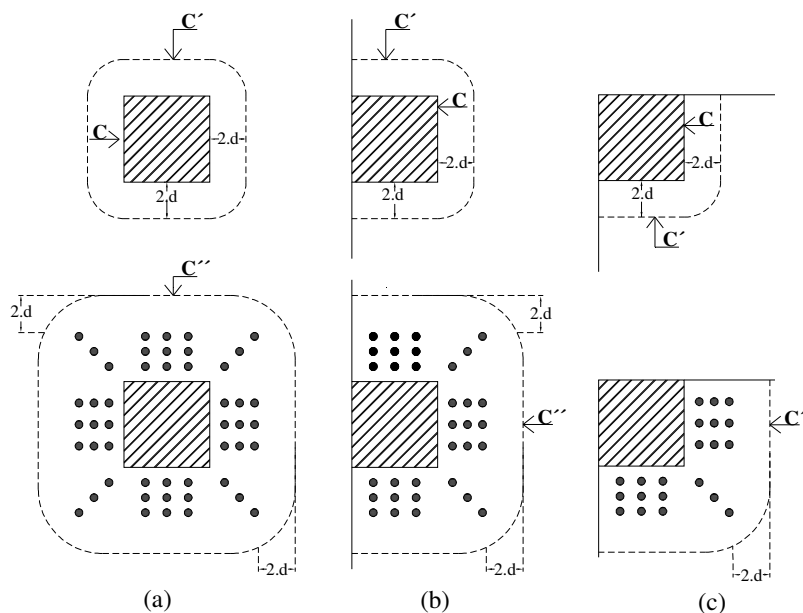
Perímetros Críticos em (a) pilares internos (b) pilares de borda (c) pilares de canto
